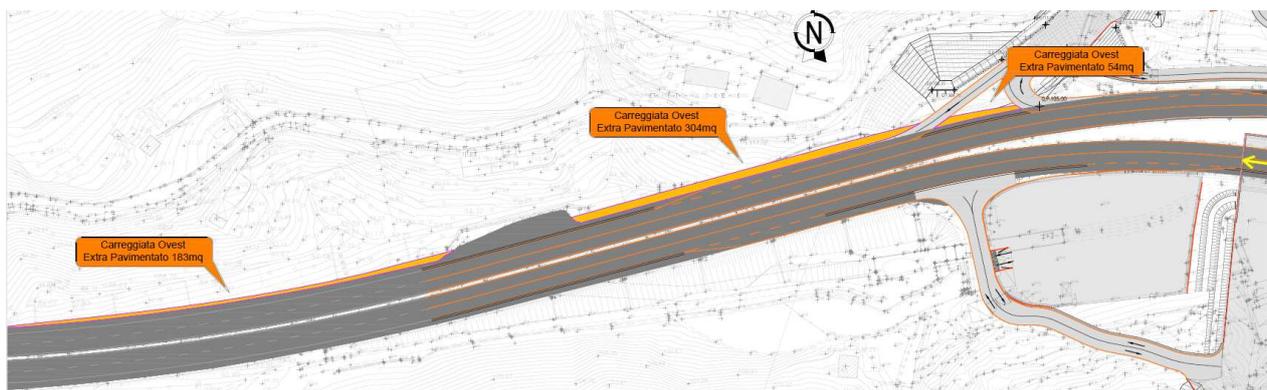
Schema di entrata/uscita in Carreggiata ovest previsto nel progetto di modifica, indicazione aree extra-pavimentate rispetto alla configurazione di progetto definitivo
